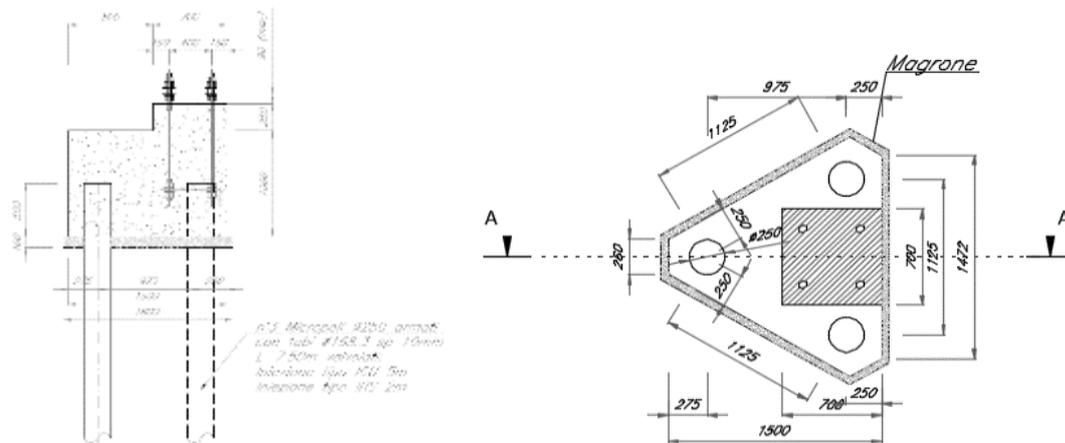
Fondazioni per pali LSU – Sezione tipologica in rilevato singolo binario – Carpenteria blocco
